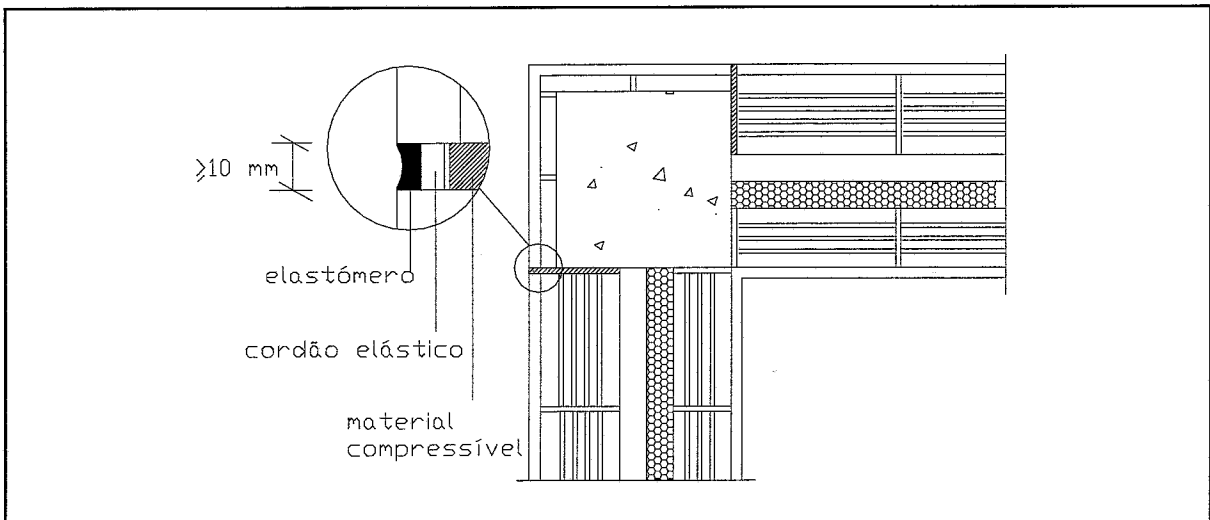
Pormenor da junta vertical de dessolidarização em zona de ligação a pilar
